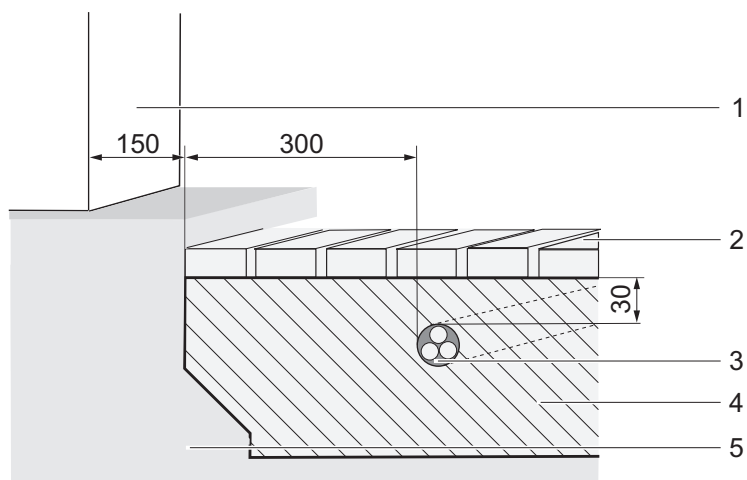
Placera induktionsslingor i bitumen, asfalt eller betong (mått i mm)
